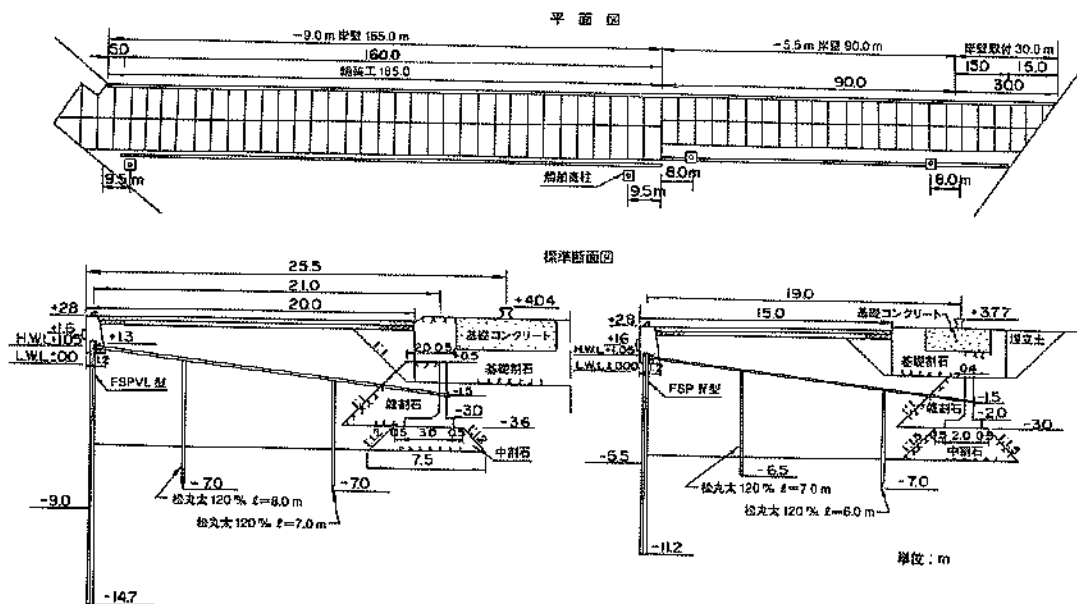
北側第2岸壁・第3岸壁平面図及び標準断面（函館港、中央埠頭）
